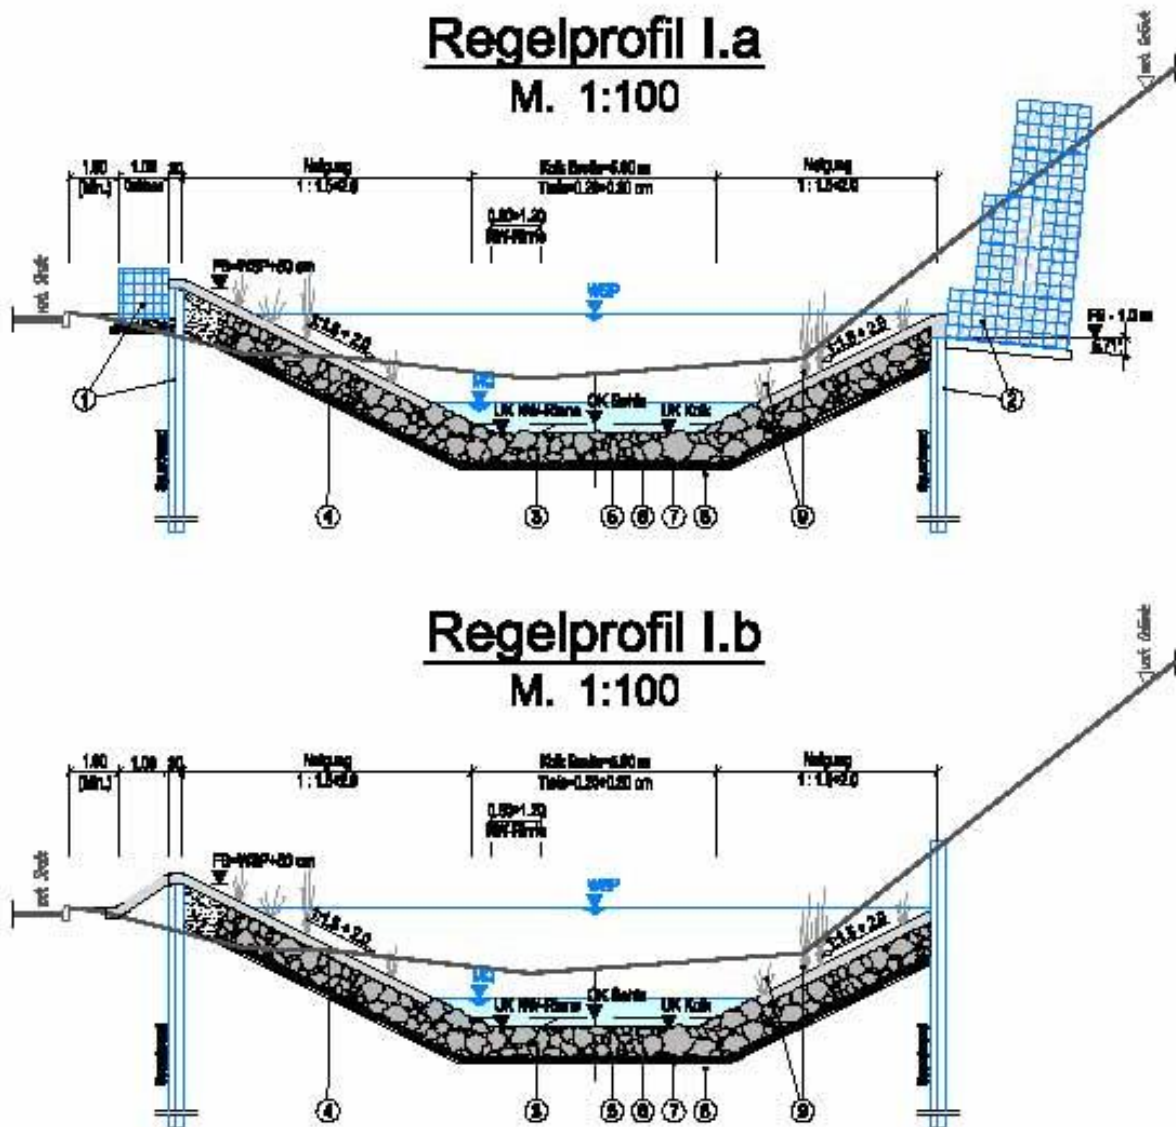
Regelprofile Planungsvariante I.a und I.b
